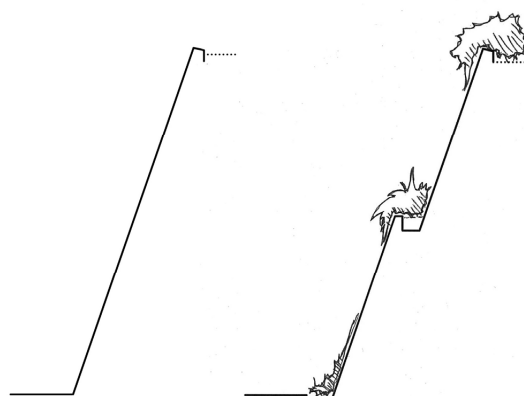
植栽等によるコンクリート面の分割/隠蔽のイメージ
